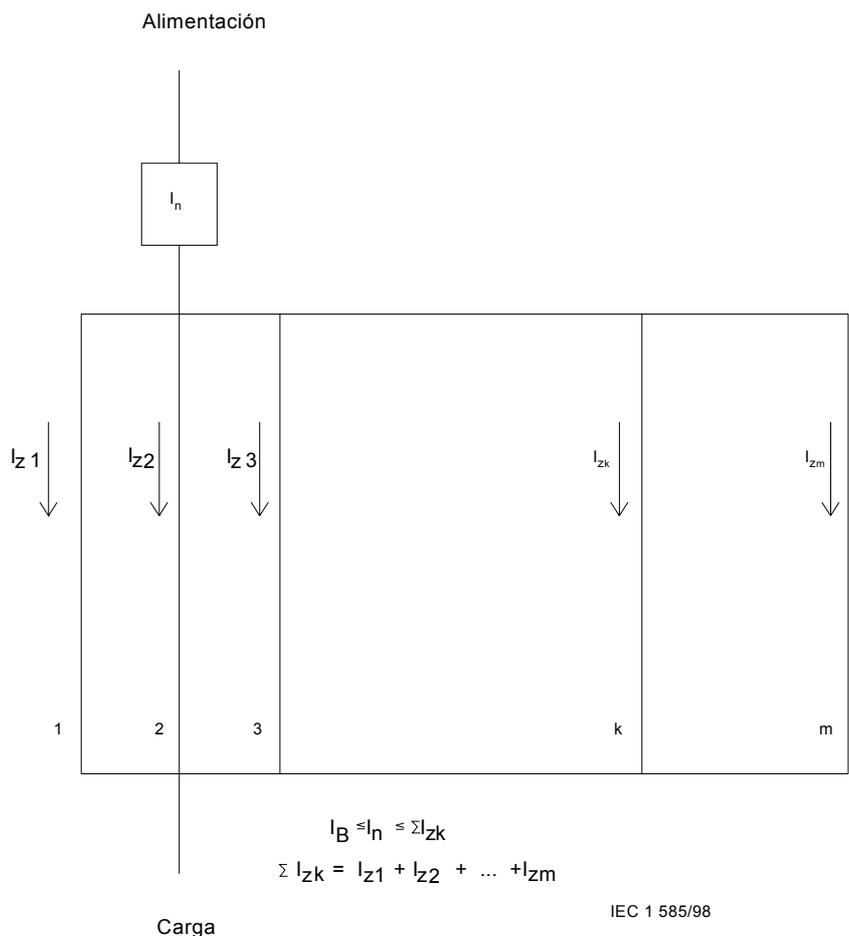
Circuito con un solo dispositivo de protección contra las sobrecargas para los m conductores en paralelo
